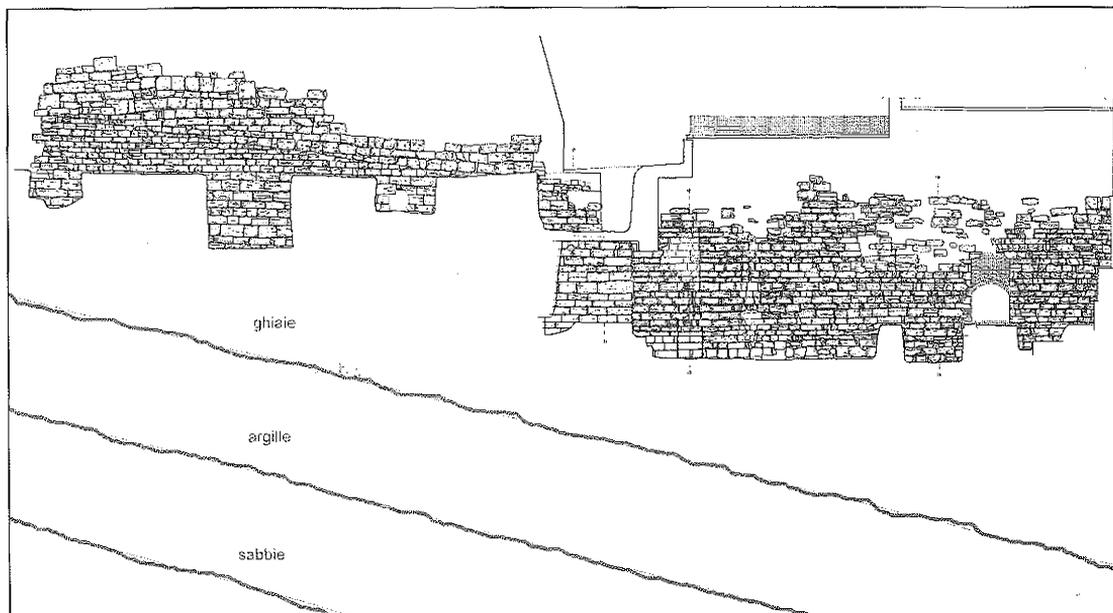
Tratto murario nella zona di San Fortunato: prospetto generale.
